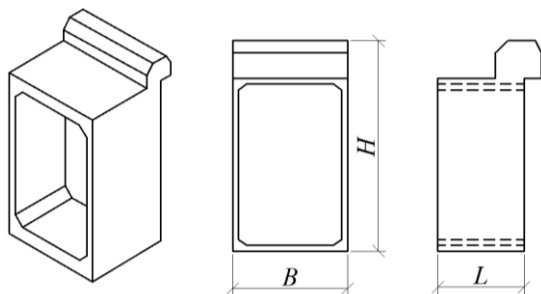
Звенья оголовка для трубы водопропускной железобетонной прямоугольной сборной
